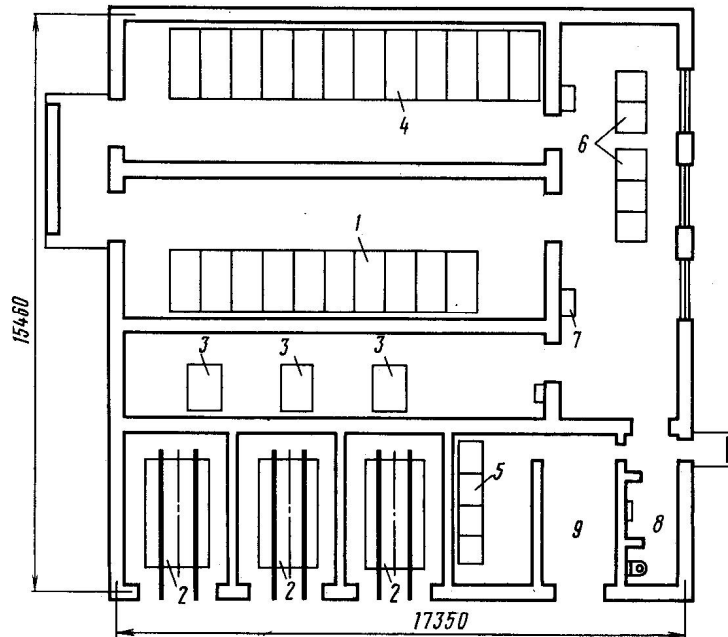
Компонівка устаткування трьохагрегатної закритої ТП:
